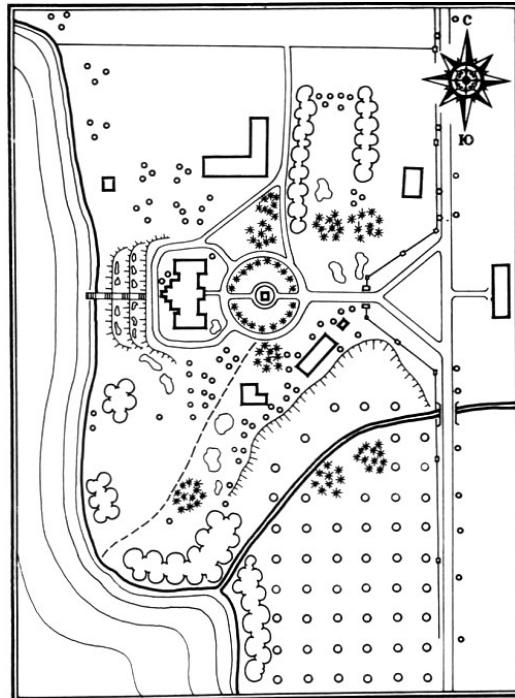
Генеральный план усадьбы Плятеров в д. Опсе
